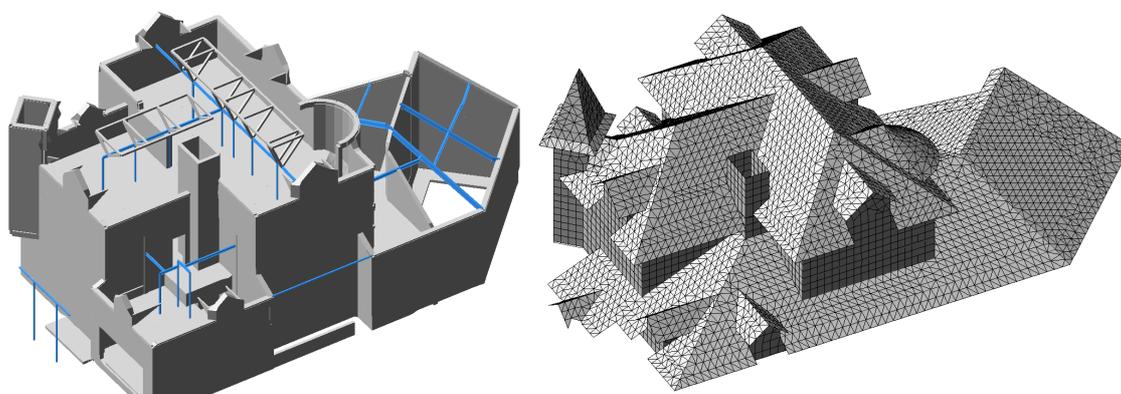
Расчетная схема основных несущих элементов стропильной системы и покрытия
